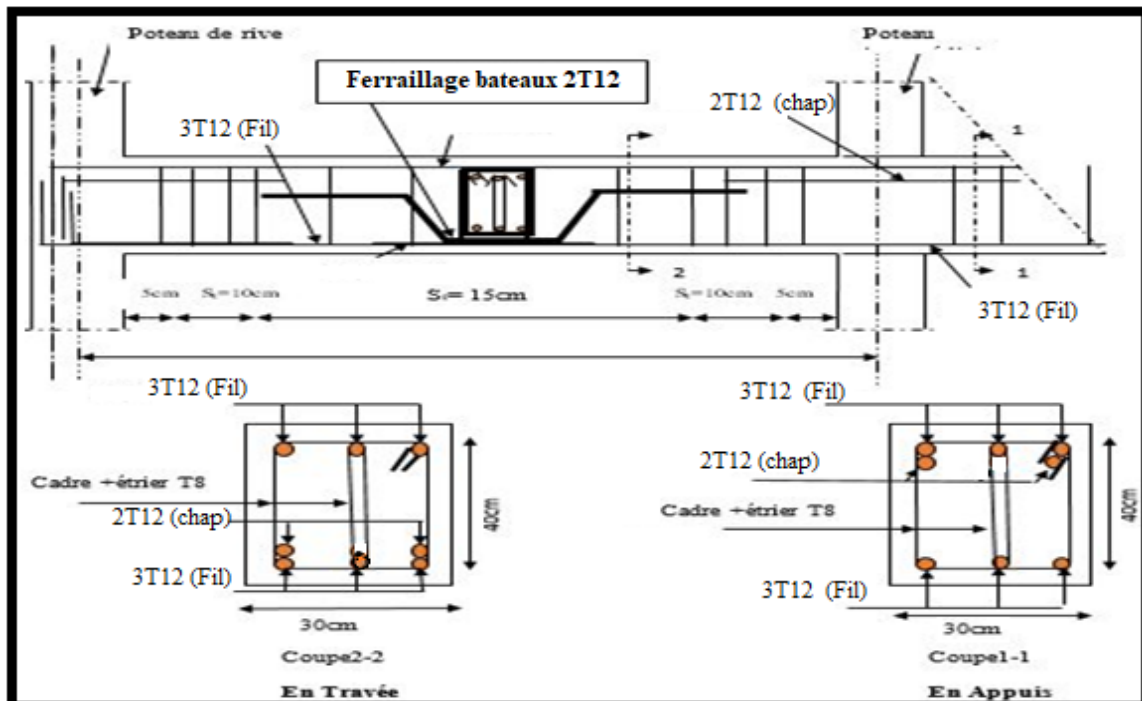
schéma de ferrailage des poutres porteuses.
